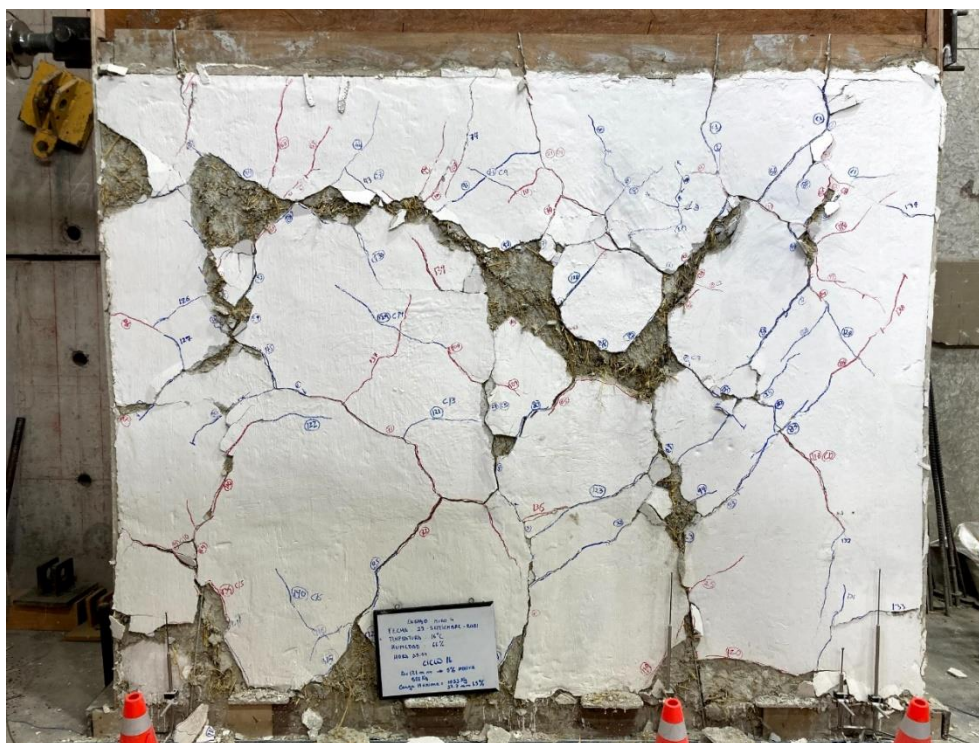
Fisuras presentadas en el muro D.
